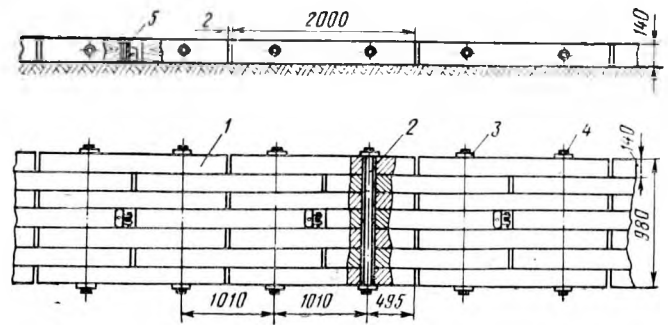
Конструкция ленточного сборно-разборного покрытия:
